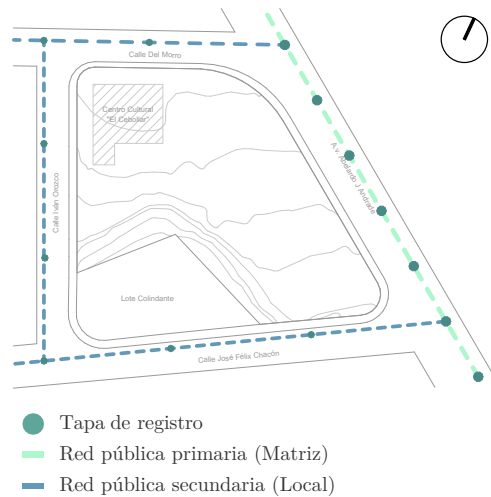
Planta Alcantarillado Público. Fuente: GAD Municipal de Cuenca.
